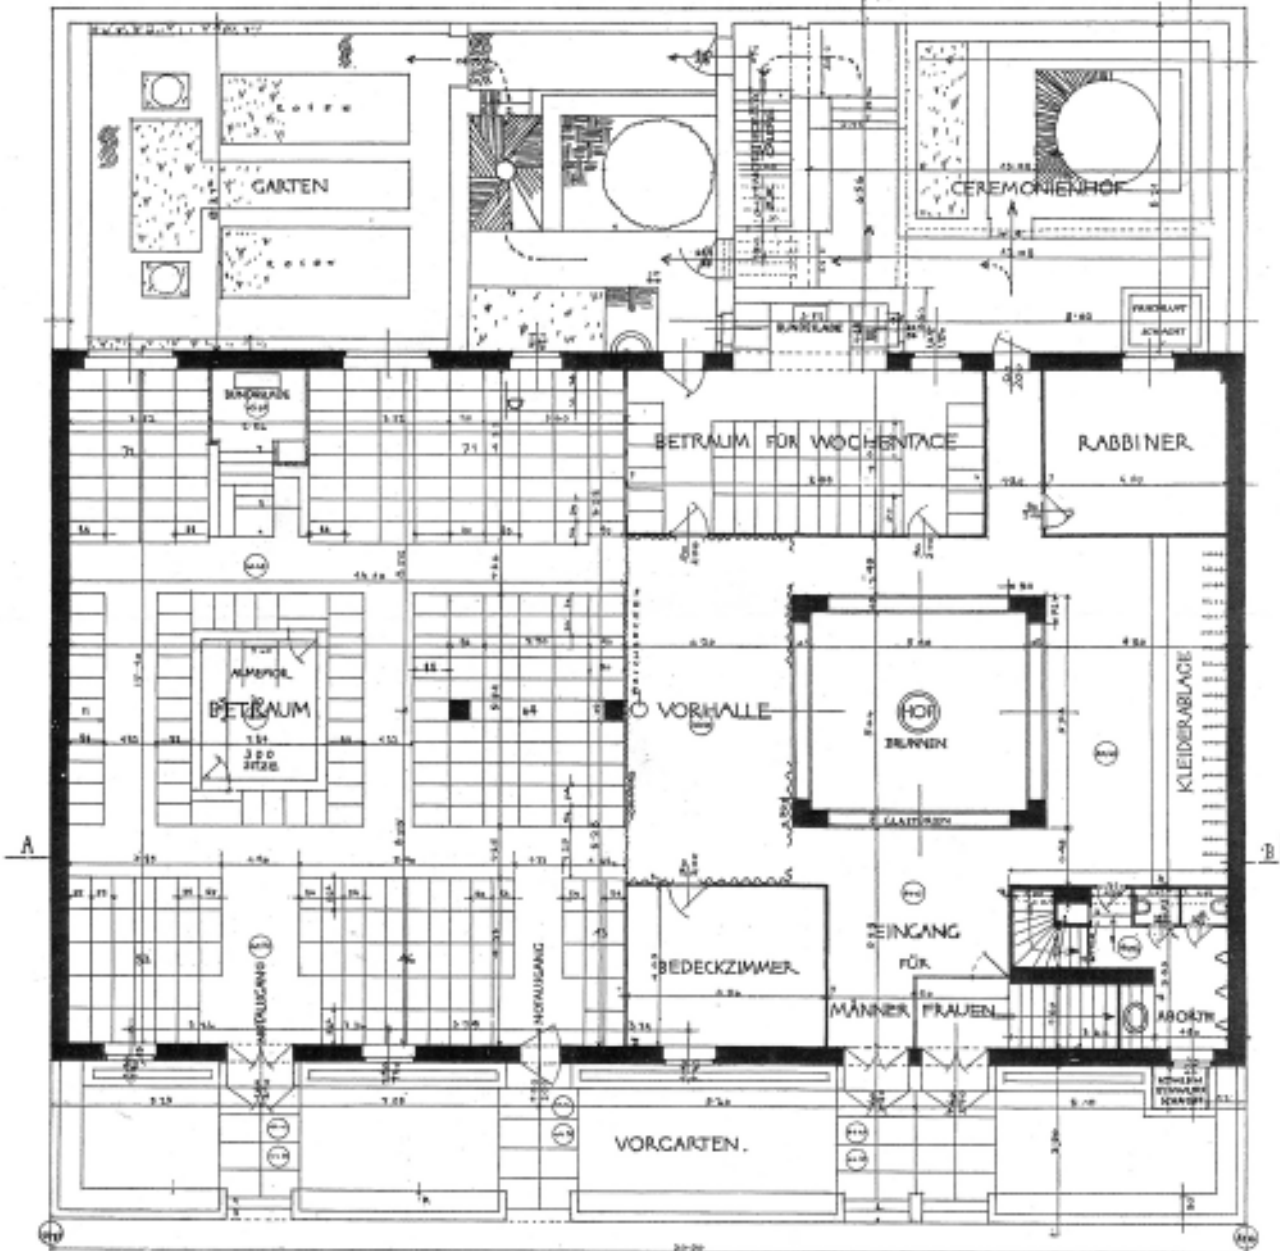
Grundriss, Hugo Gorge 1912
